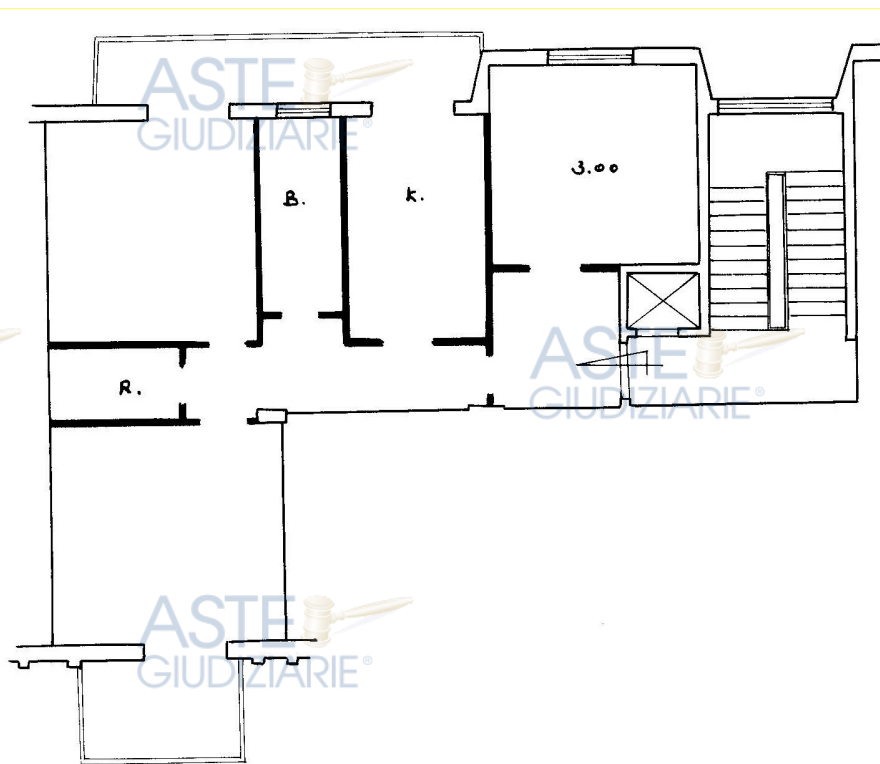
Planimetria catastale dell'appartamento oggetto di stima part. 425 sub 41
